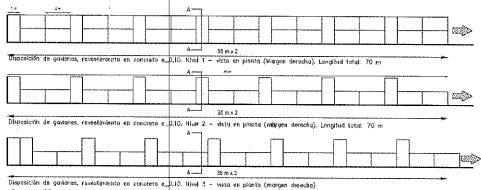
Disposición en planta niveles de muros en gavión margen derecha. Documento Tecnico, Cenit 2020.
